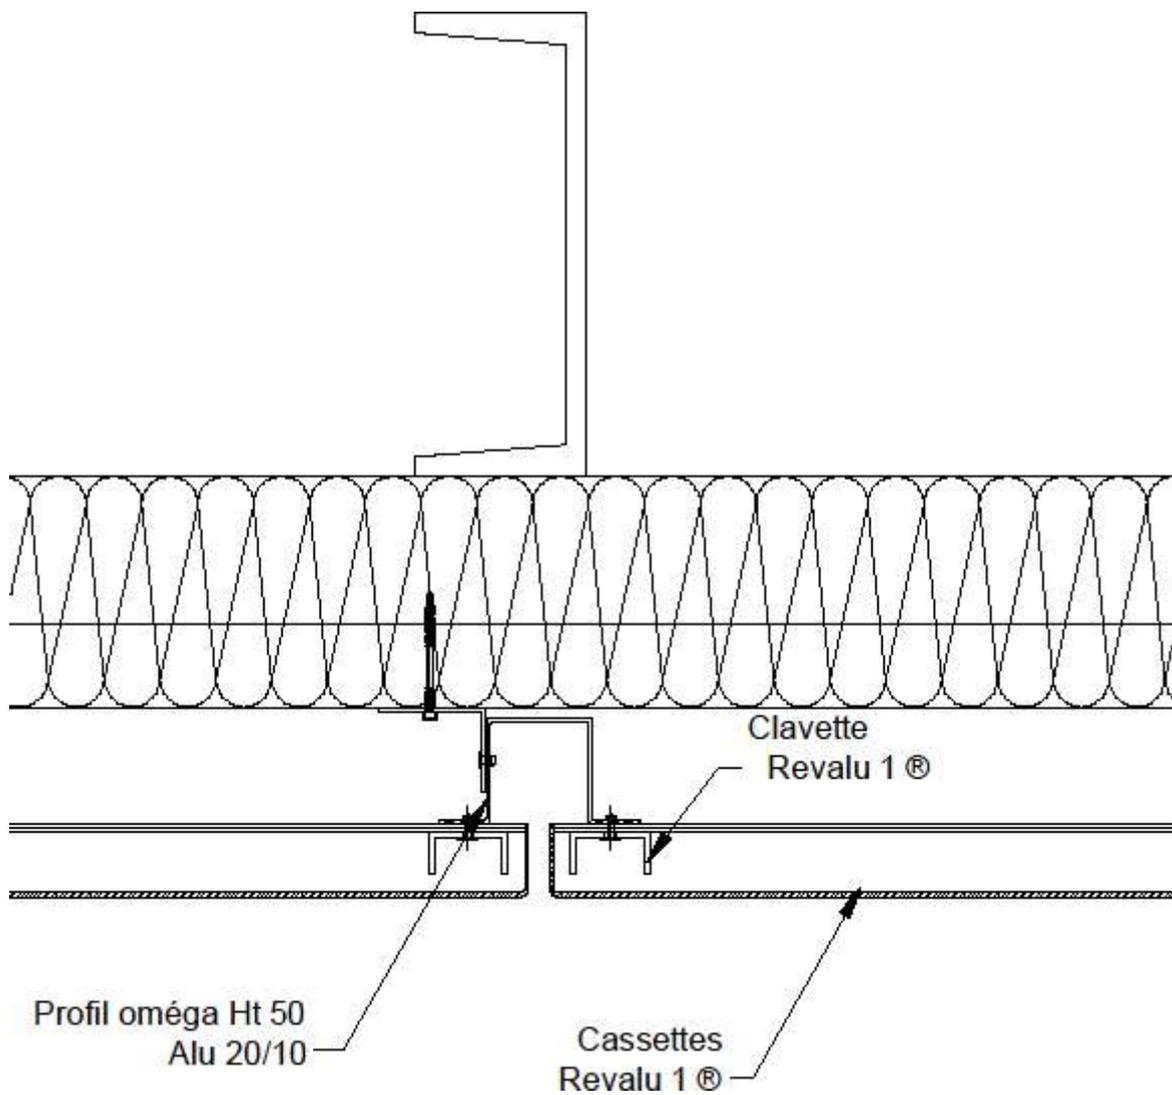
Coupe horizontale sur joint vertical (support bac plateau)
